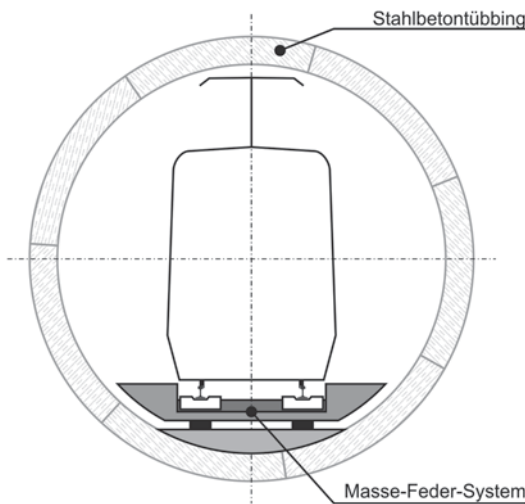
Eingleisiger Streckentunnel mit Masse-Feder-System nach Dr. Mattner
